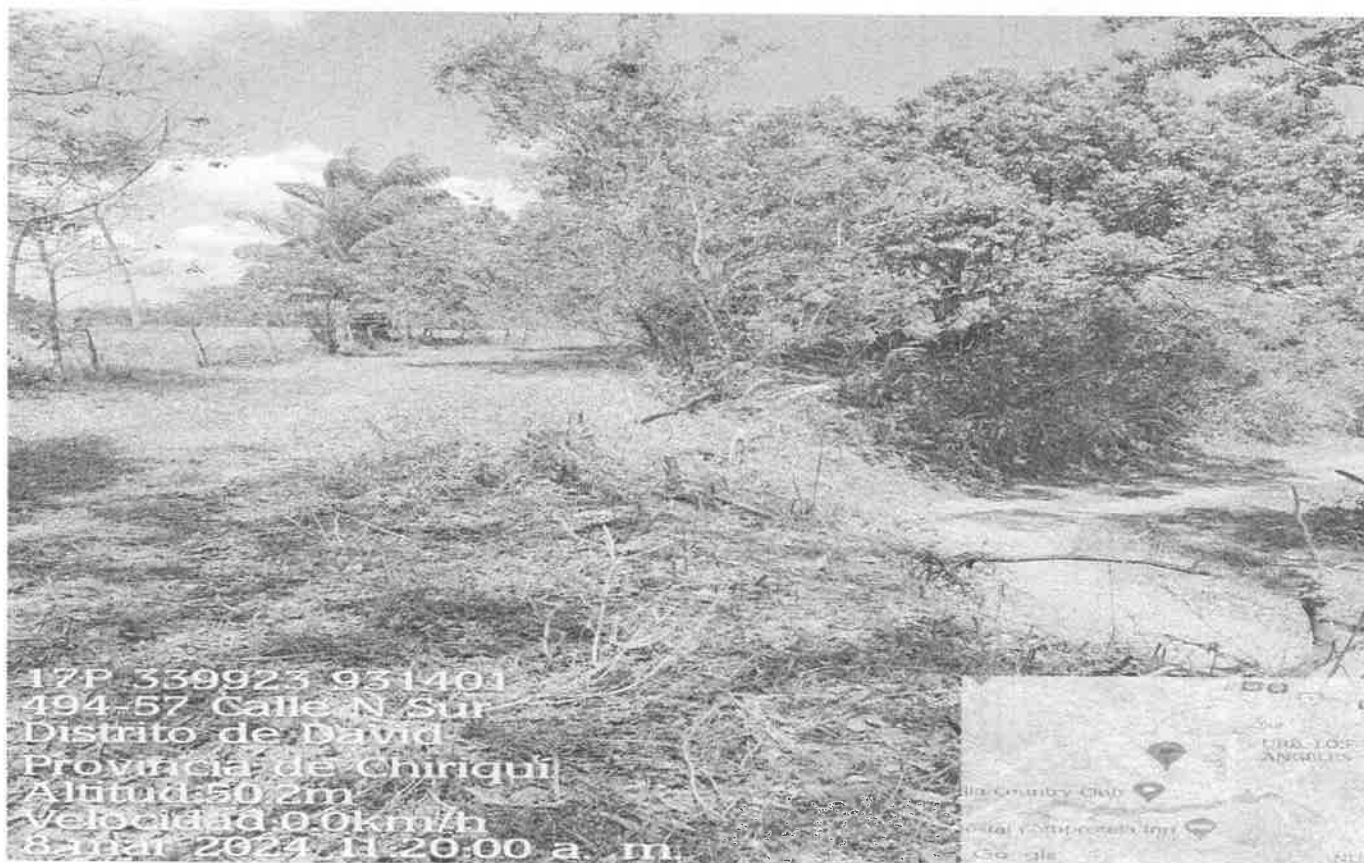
Área más alta de los polígonos de intervención donde se realizarán trabajos de cortes y banquetas
